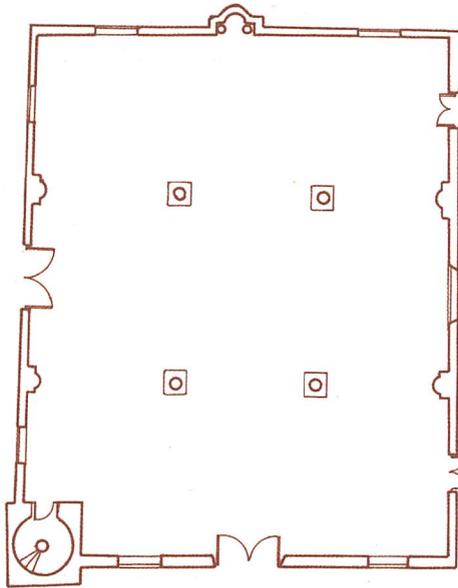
المسقط الأفقى لمسجد وضريح أبو مندور برشيد
